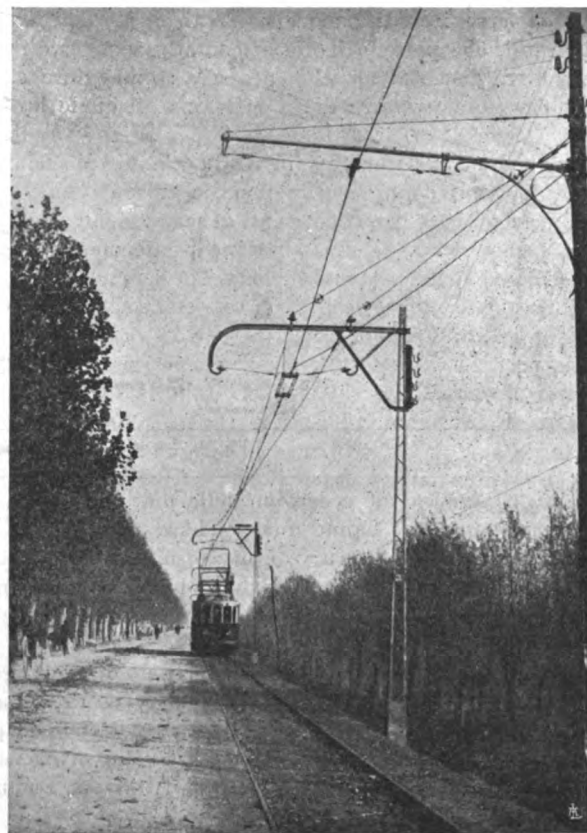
Passaggio dall'alta alla bassa tensione.
